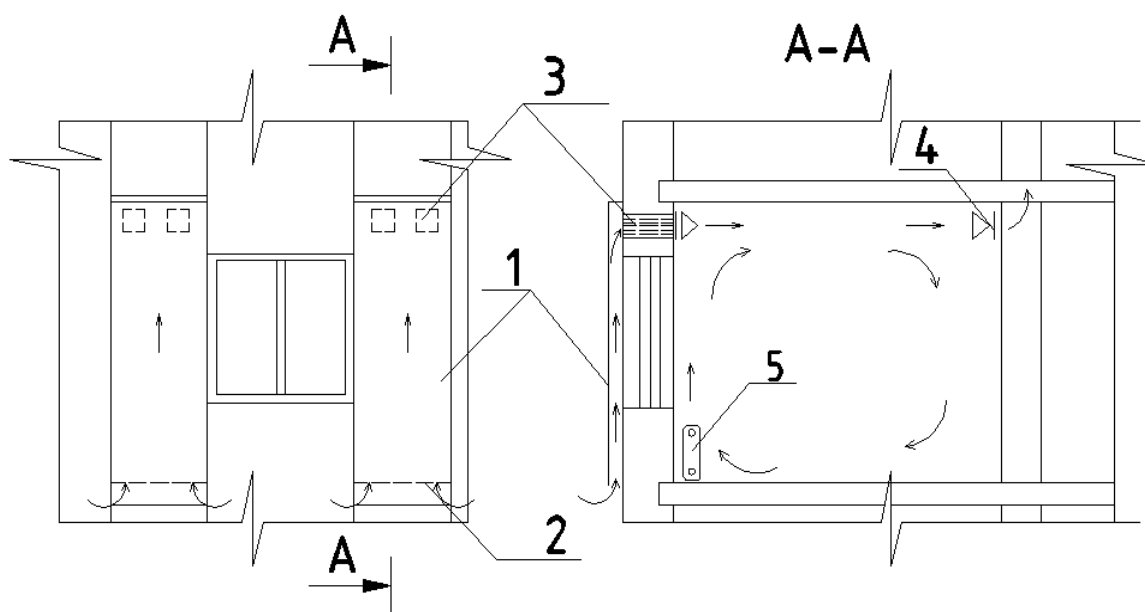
Устройство фасада здания с рекуперативными приточными вентиляционными блоками: 1 – навесной фасад; 2 – щелевые зазоры; 3 – вентиляционное приточное устройство типа РПВЭ; 4 – вытяжная решетка; 5 – отопительный прибор
